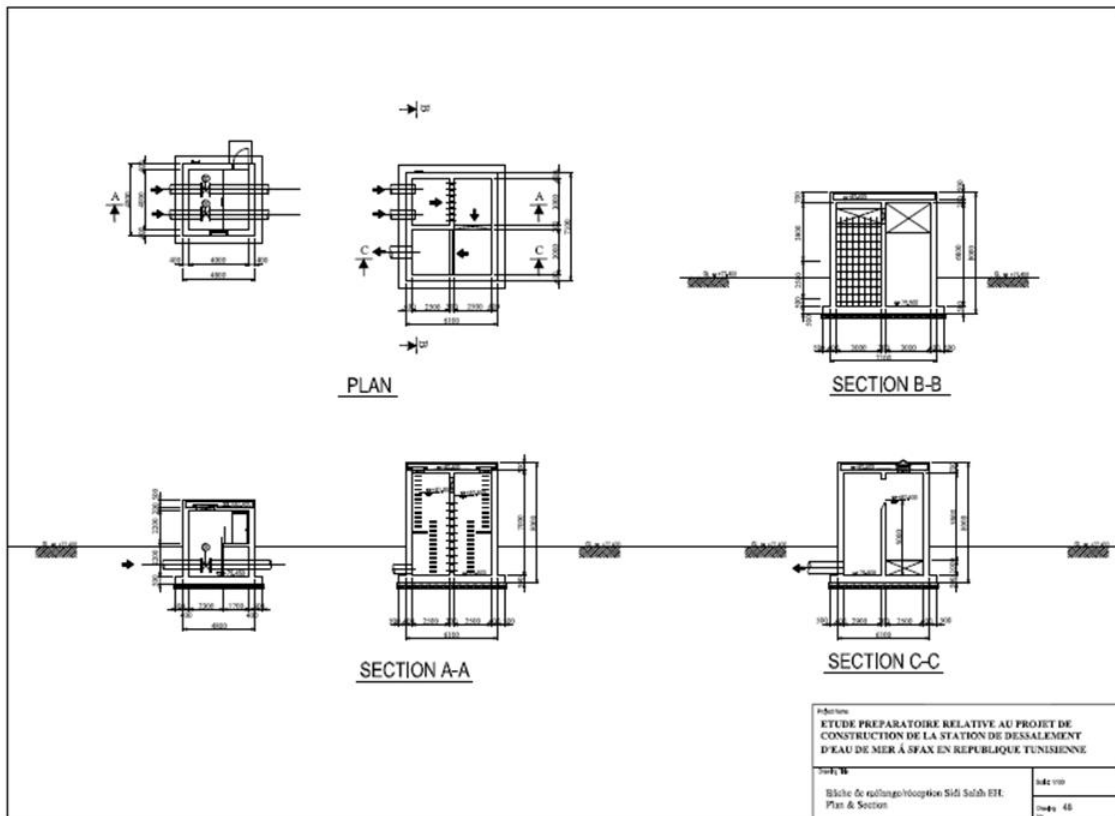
Bâche de mélange Sidi Salah, plans et sections
